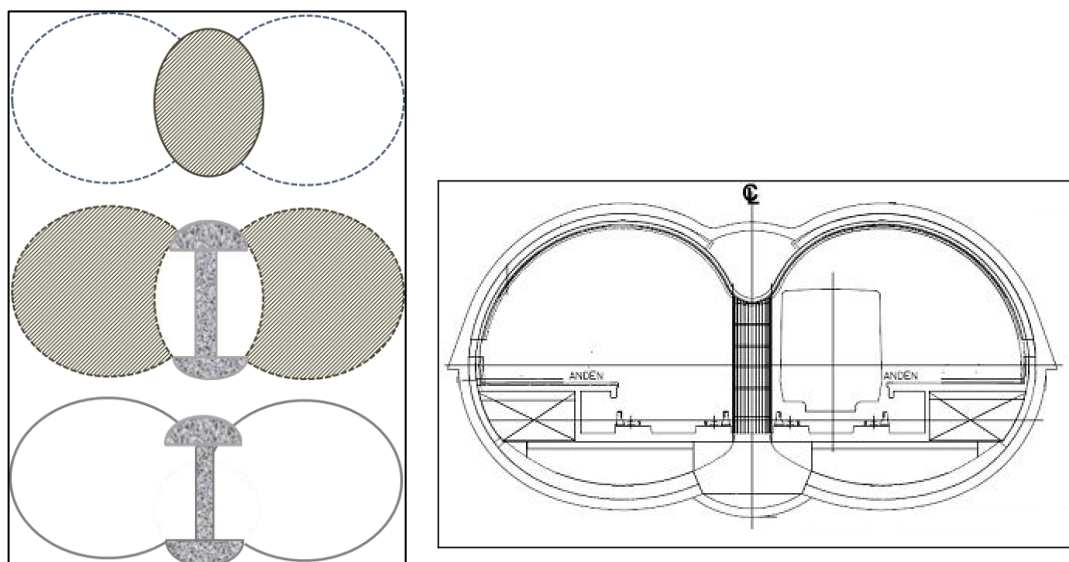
Secuencia de Excavación para un túnel con metodología de excavación tipo “binocular”
